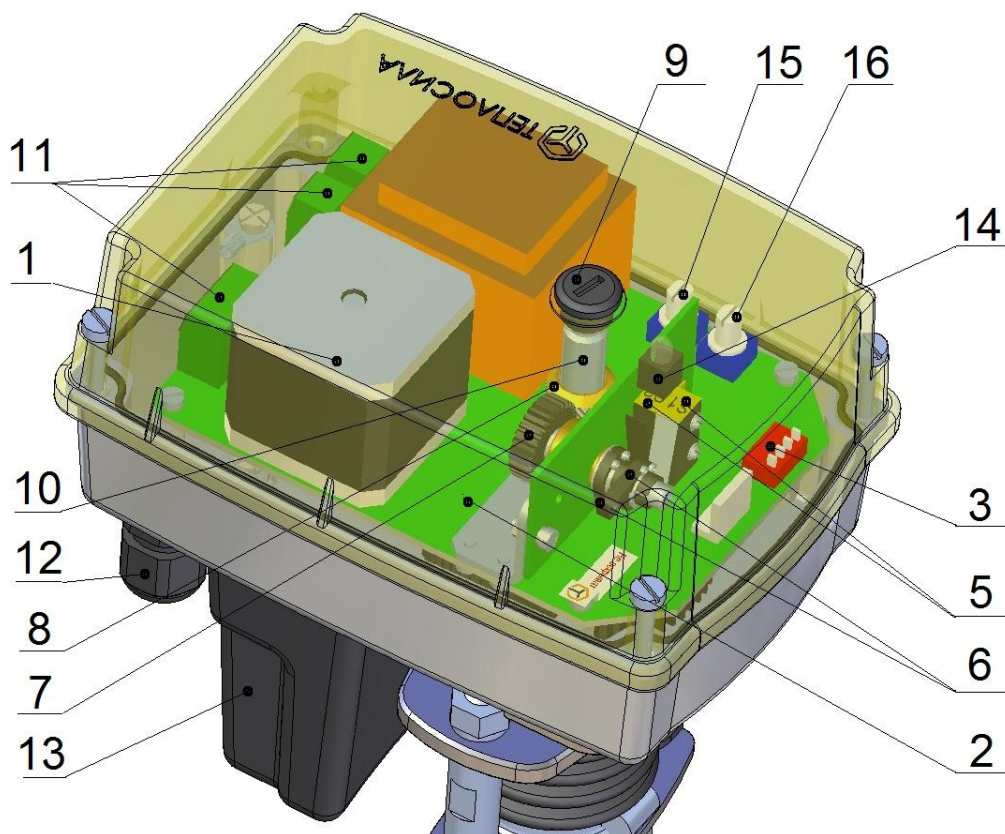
Общий вид TSL-XXXX-XX-2T-230
